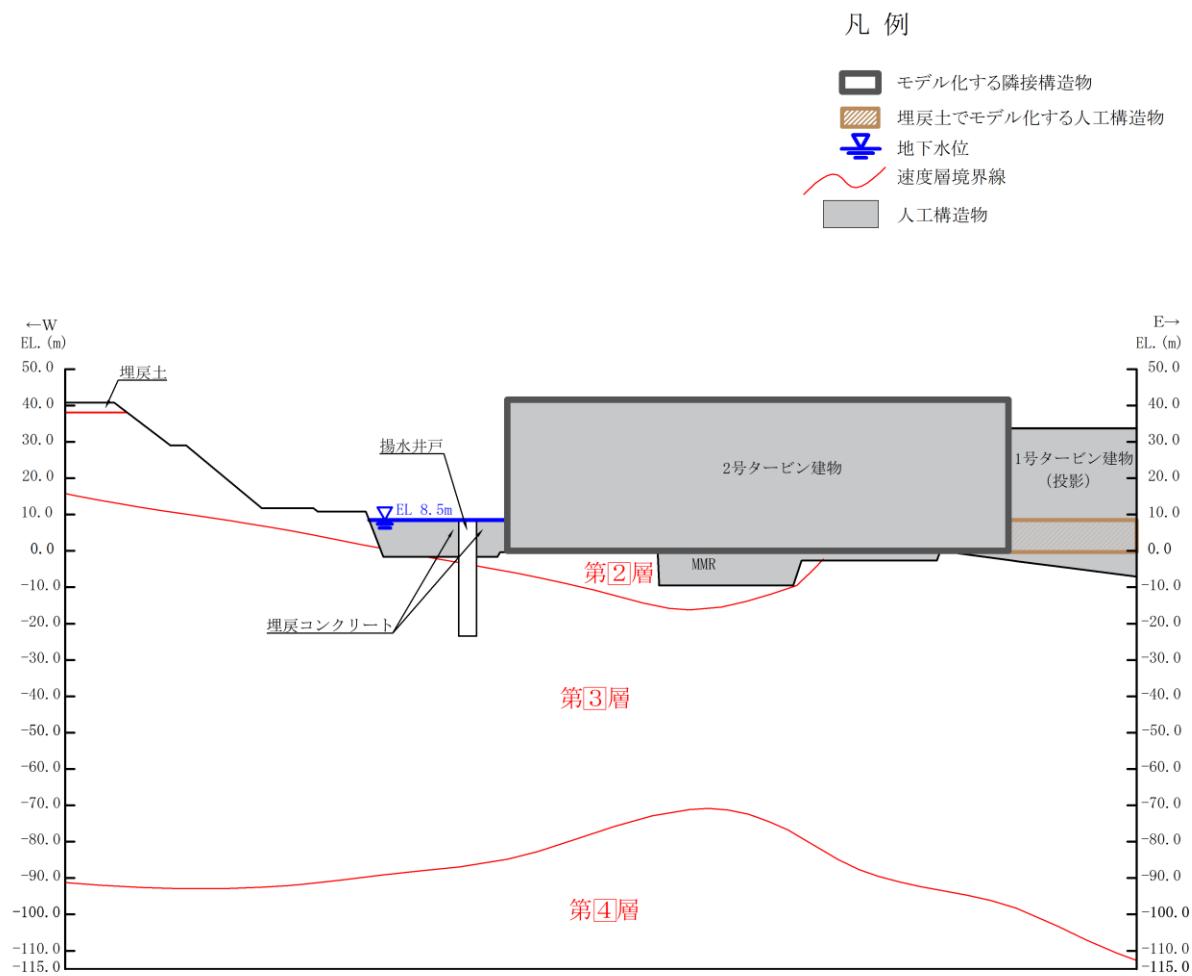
評価対象断面図 (A-A 断面 (東西方向))
